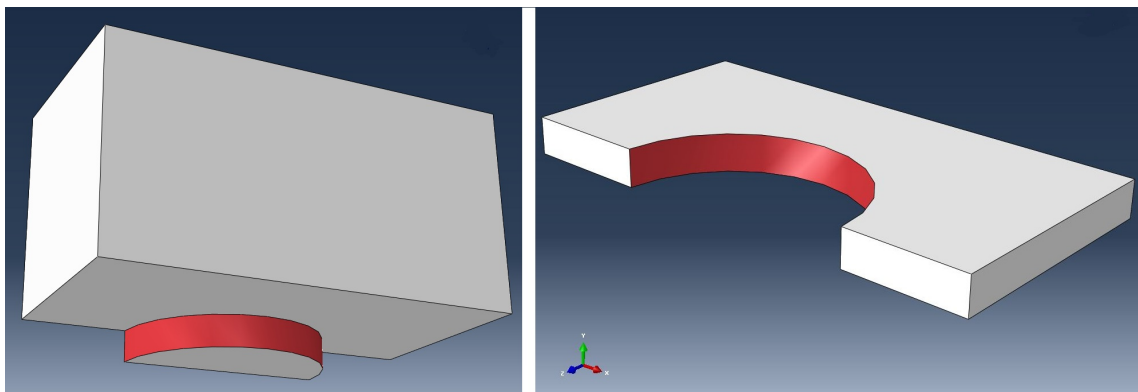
vertikale Kontaktfläche von Beton und Stahlblech
